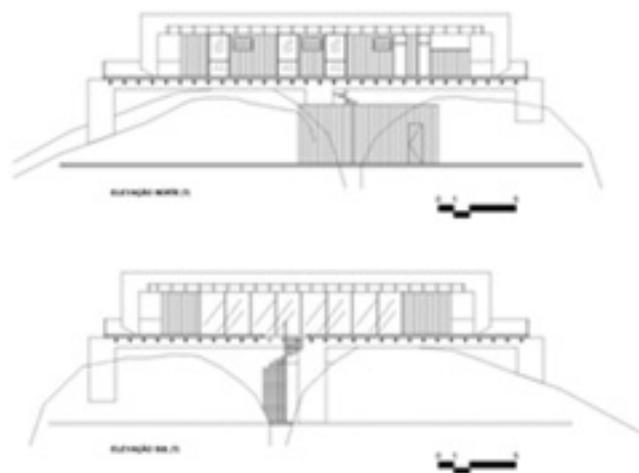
Elevação Leste/ Elevação Oeste. Fonte: desenho da autora sobre projeto original
